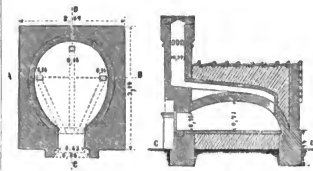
Grundriss und Durchschnitte eines Normal-Badofens.
